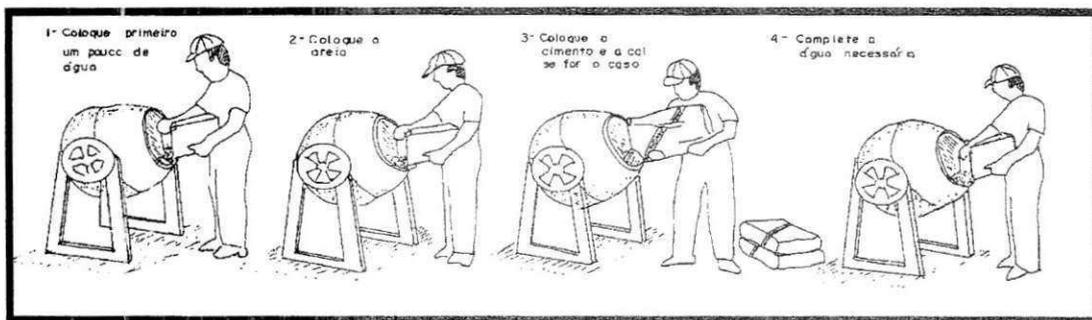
Preparação da argamassa de assentamento de alvenaria com betoneira
